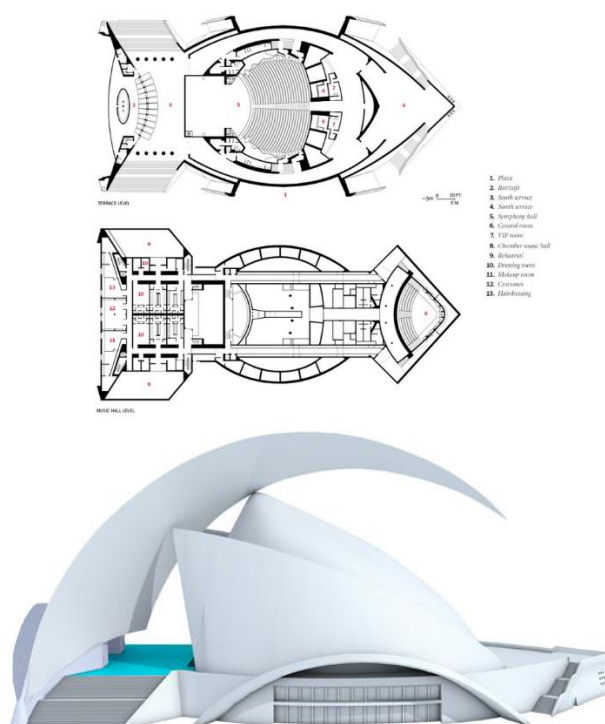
Vista de planta y lateral del teatro de Tenerife.
